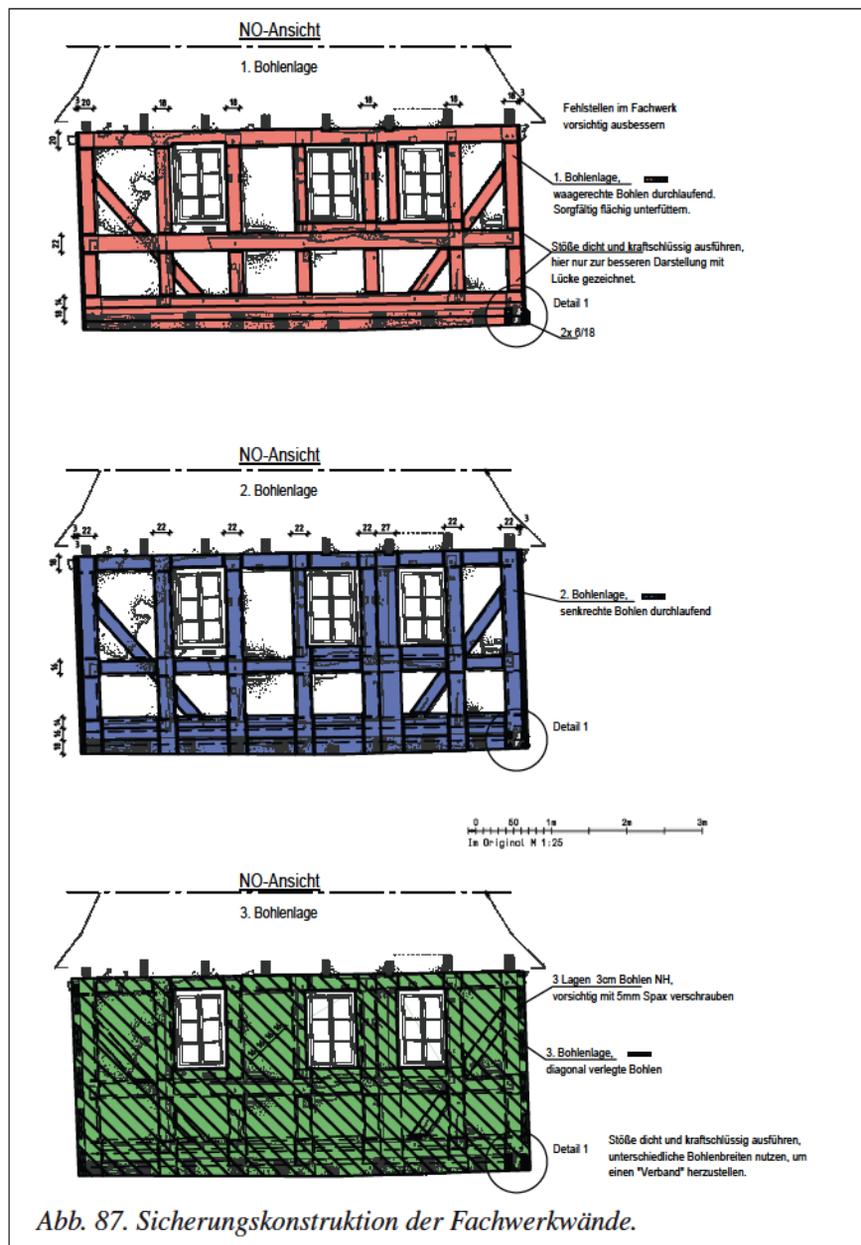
Sicherungskonstruktion der Fachwerkwände.
